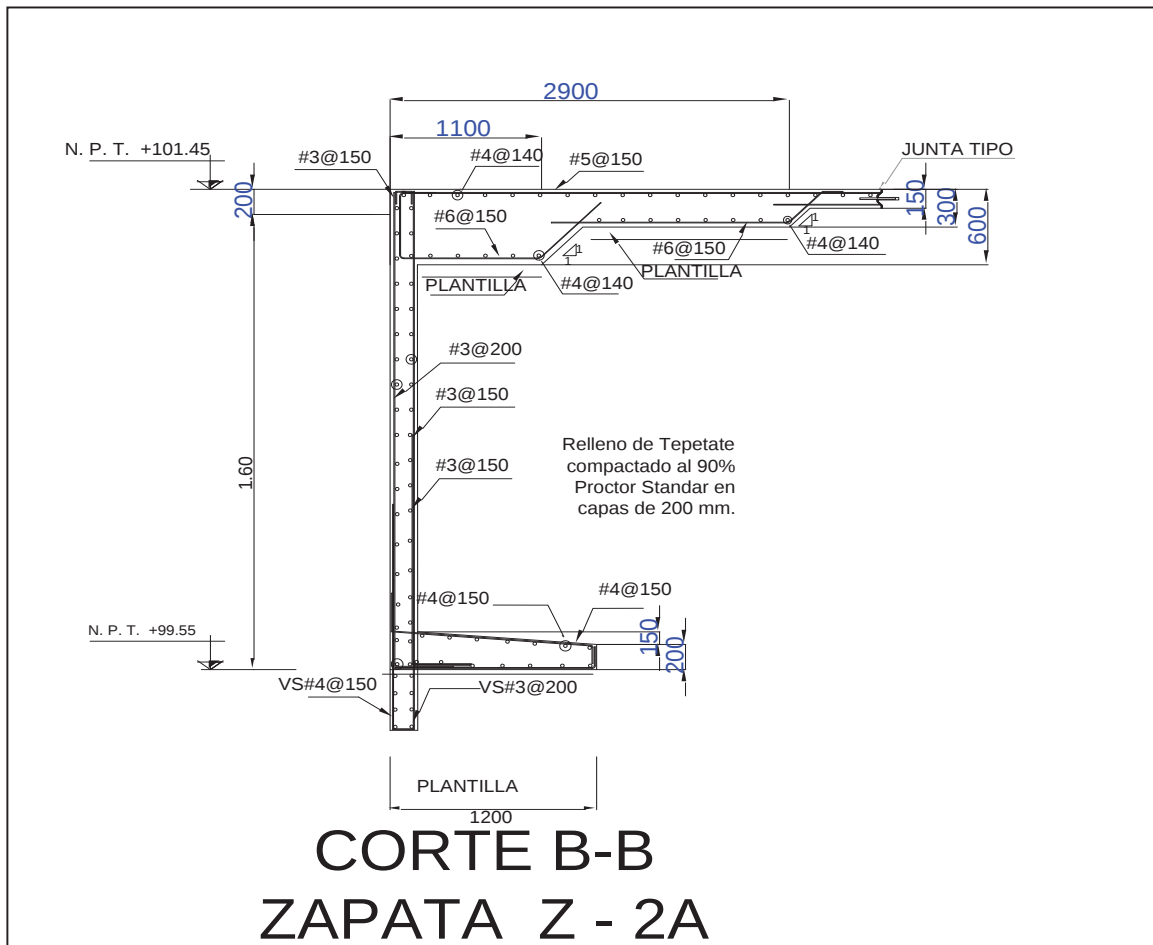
Muestra la sección transversal de la zapata del eje "A y H"
